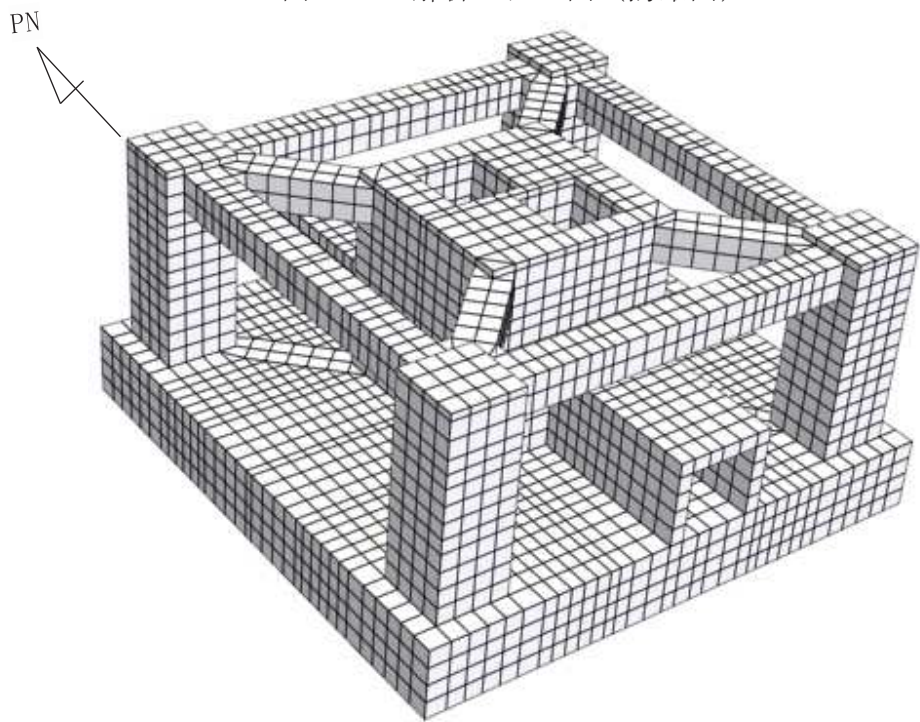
解析モデル図 (鳥瞰図 (充填コンクリート非表示))
